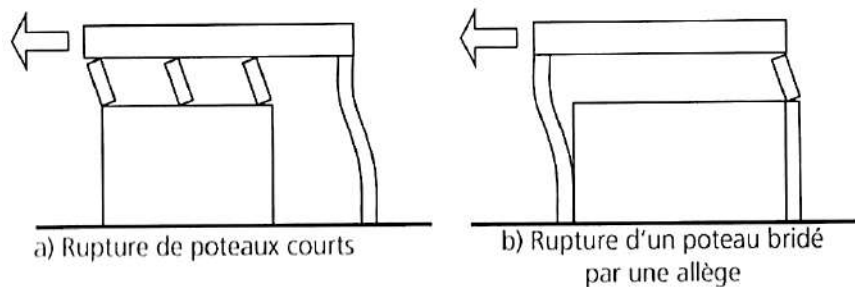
Cisaillement du poteau court et poteau bridé [15]
